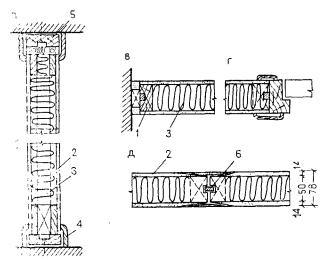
Панельные перегородки из небетонных материалов — примыкание к потолку; δ — примыкание к полу; θ — примыкание к стене; ϵ — примыкание к дверной коробке; ∂ — вертисынный стык; I — каркас; 2 — обшивка; 3 — звуконзоляционный слой; 4 — плинтус; 5 — обвязка; 6 — стыковая рейка
